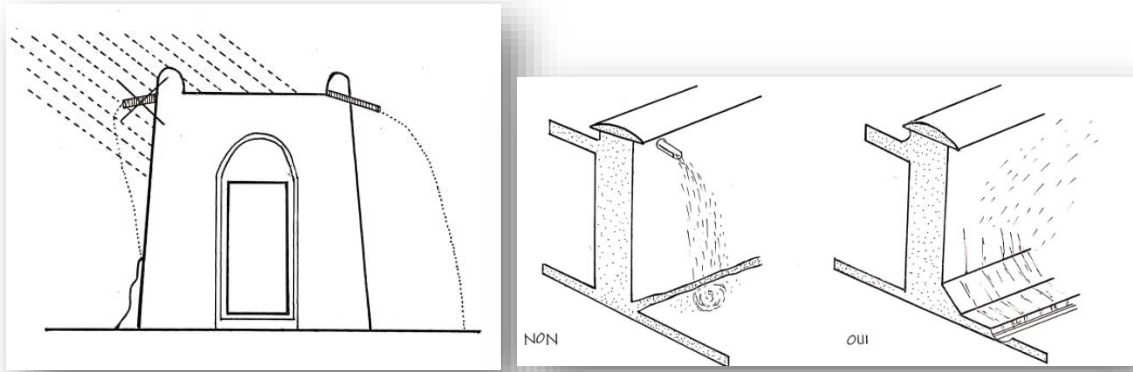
Disposition à prendre pour diminuer le rejaillissement des eaux pluviales sur le mur.
